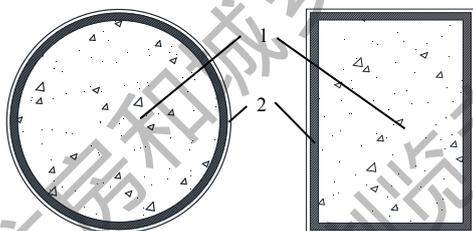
钢管混凝土防火涂料防火保护构造
